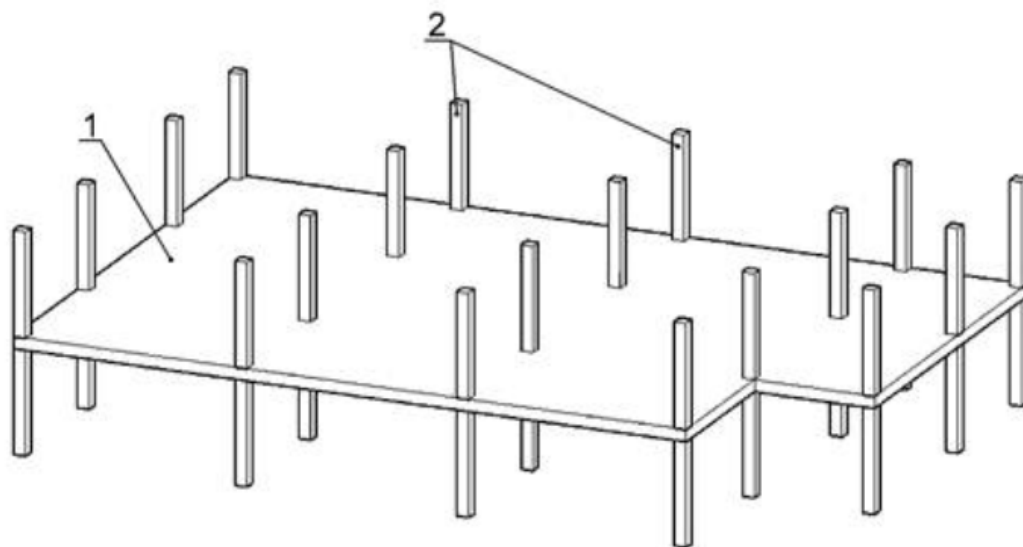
Каркасно-монолітна конструктивна схема. 1 - плита перекриття; 2 – колони [65]
